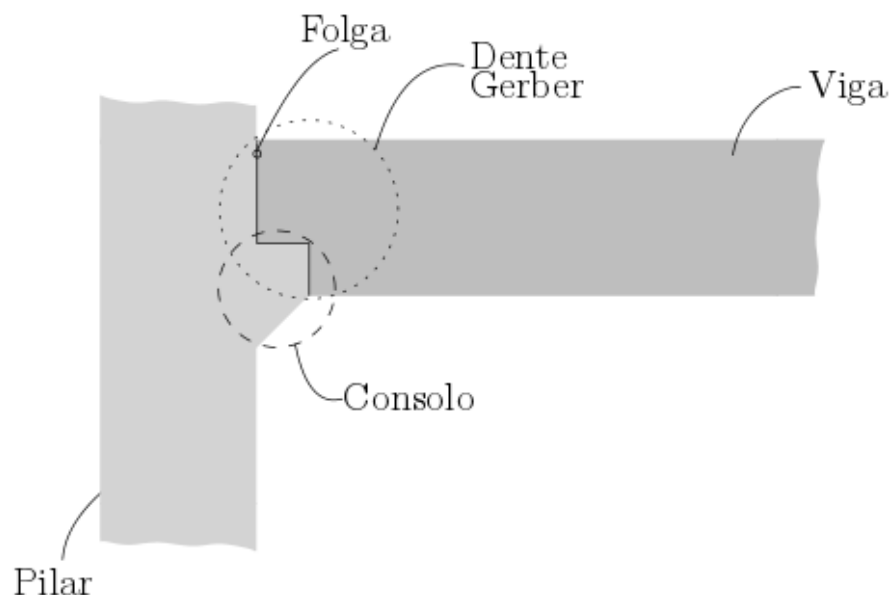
Detalhe típico de ligação viga-pilar pré-fabricados.
